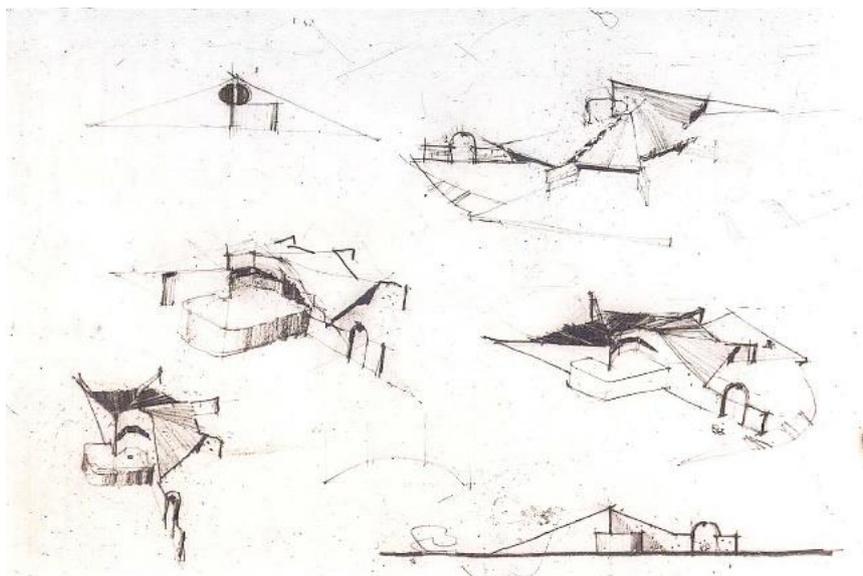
De um lado a bela vista do Lago. Do outro a área menos privilegiada, separadas por um muro de tijolos. Croqui de José Galbinski.
